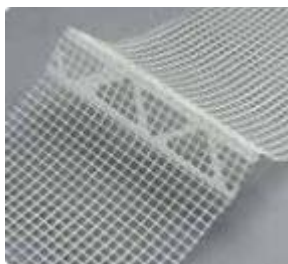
Perfil perfurado em PVC com rede para reforço de esquina (Saint-Gobain, 2016)
